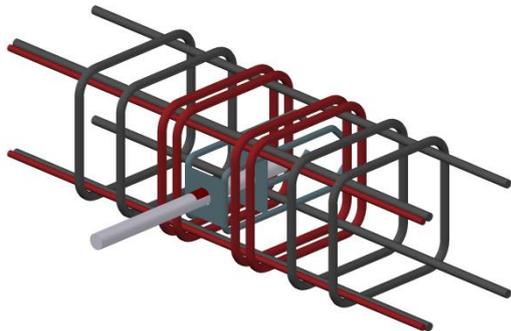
Disposición de los cercos de la armadura de suspensión y armadura de la viga de borde. Vista tridimensional.
